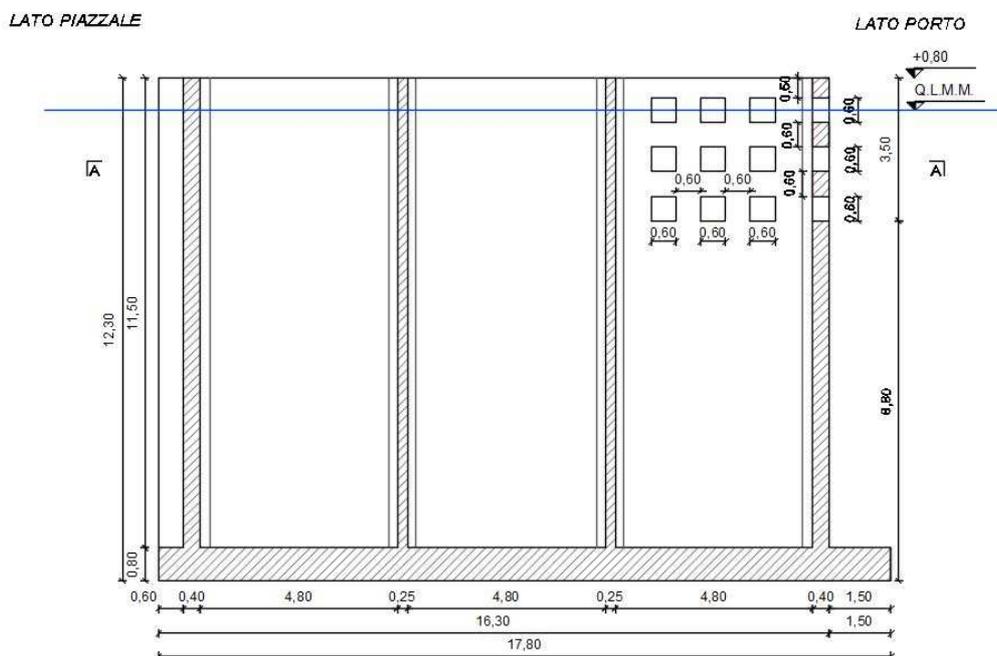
Cassone tipo 3: Carpenteria - Sezione verticale longitudinale F-F
